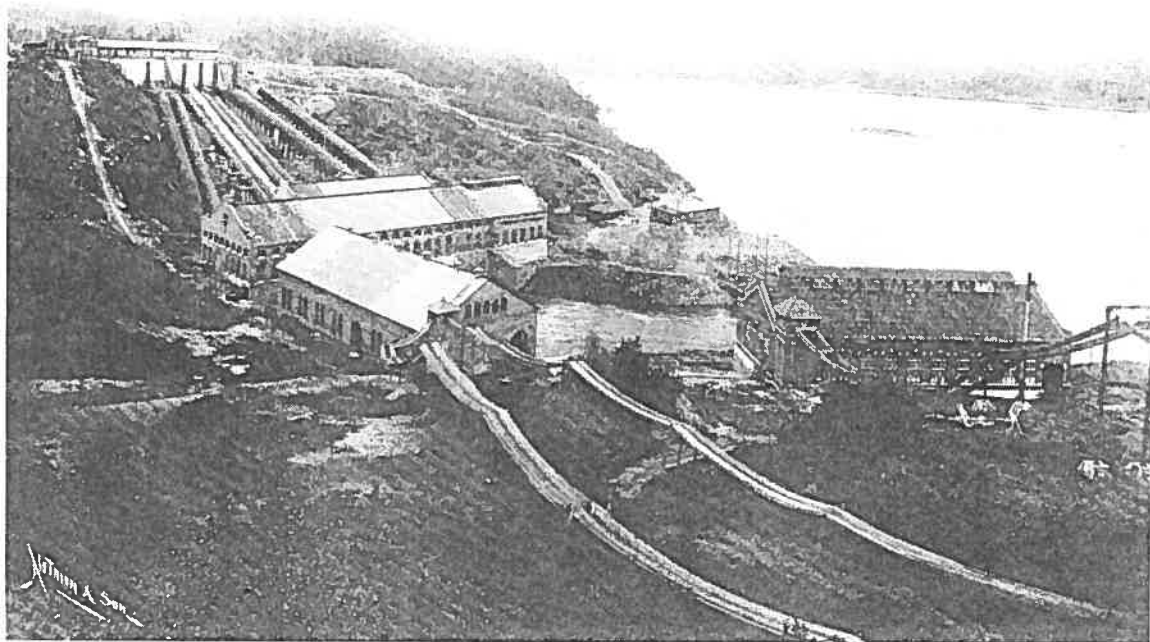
Les premières installations hydroélectriques construites au début du XXe siècle
